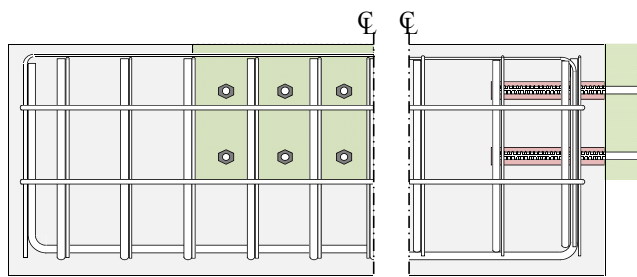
試験体配筋図 (SD345, 試験体 No.1, No.2)
